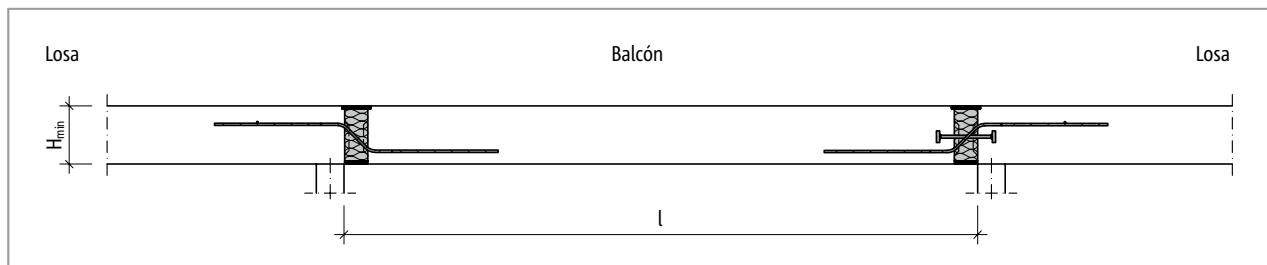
Schöck Isokorb® T tipo Q-PZ, Q-P: Sistema estático
